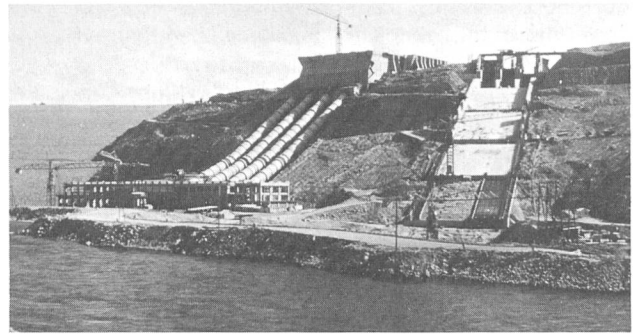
Im Hintergrund links der nahezu vollendete Damm. In Bildmitte Fassungsbauwerk, Druckleitungen und Zentrale. Rechts davon Hochwasserentlastung mit Einlaufbauwerk und Schusssrinne.
